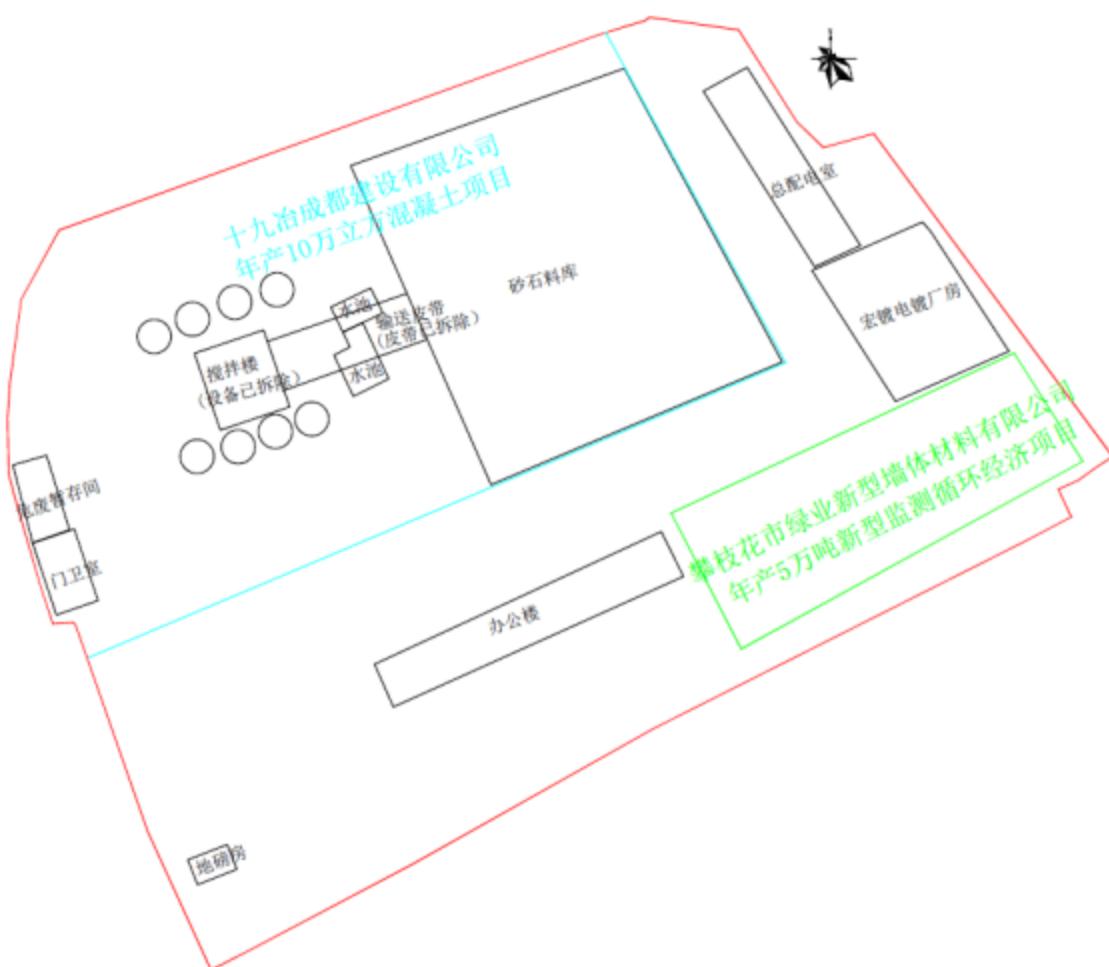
宏镀工贸红线范围内现状平面布置图示意图
